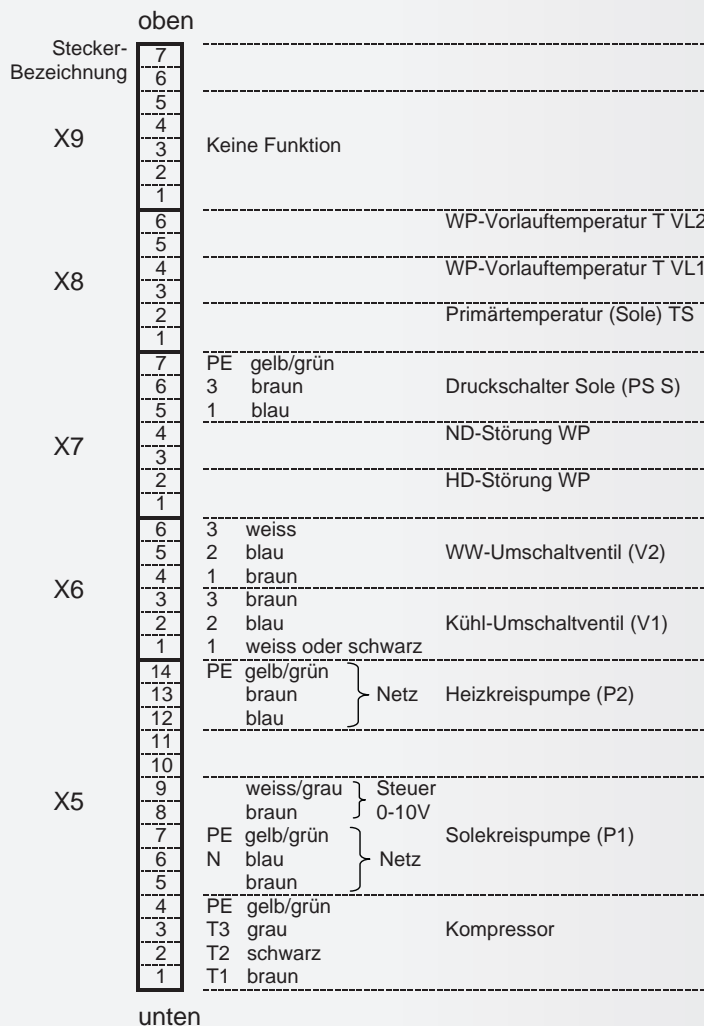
Steckerbelegung auf Rückseite Control Panel
